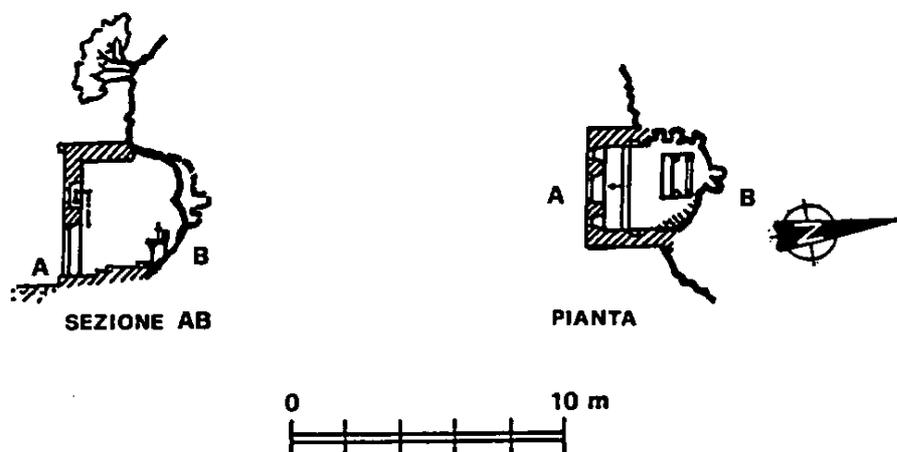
Planimetria della grotta (fonte: Felici – Cappa 1989).
